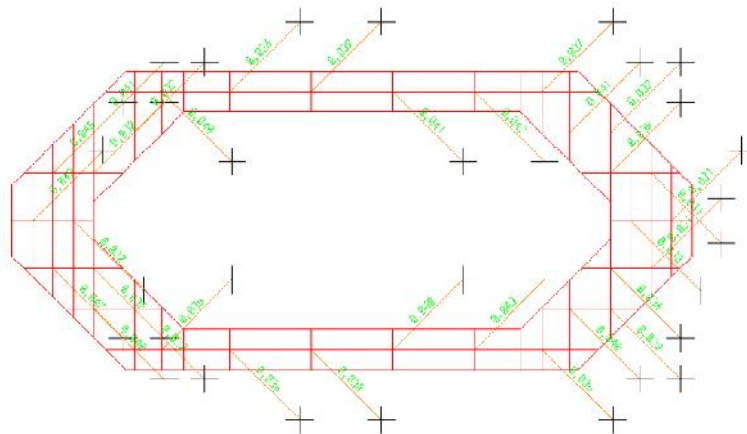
Sketsa bangunan pelindung pilar
